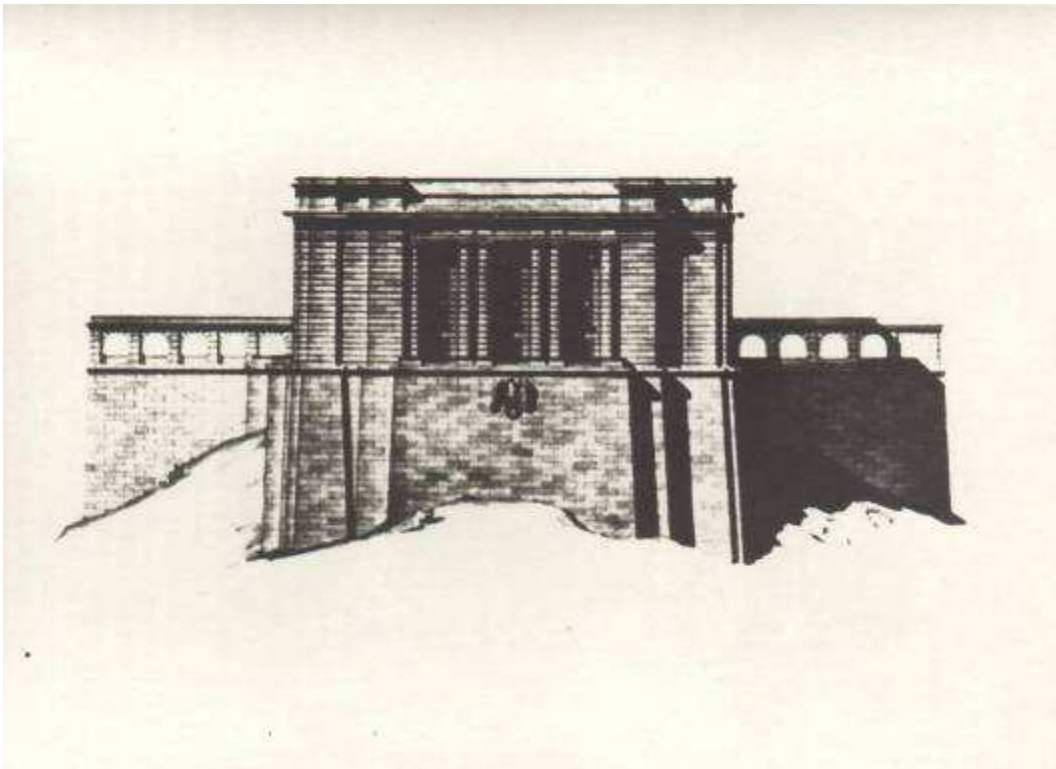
Otto Strohmayer, Stadtansicht, Gauhalle, Baukörper 1, Imbergverbauung, Salzburg, März 1942 (Sammlung Braumann).
